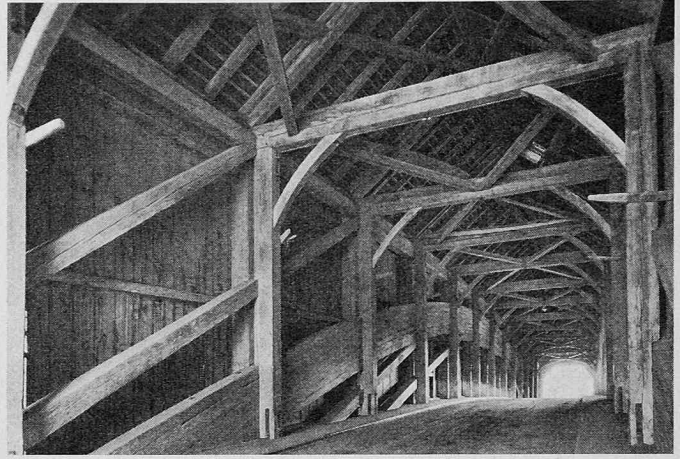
Hasle: Aus sieben Balkenlagen verzahnter Bogen. Man beachte oberen Windverband und Dachbinder mit vertikalen Pfosten
